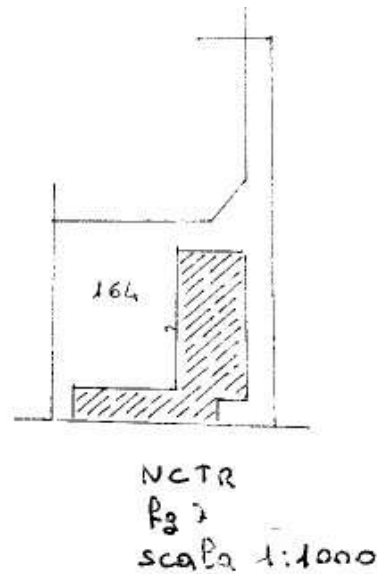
Estratto planimetria catastale fig. 7 map. 164 sub. 7
